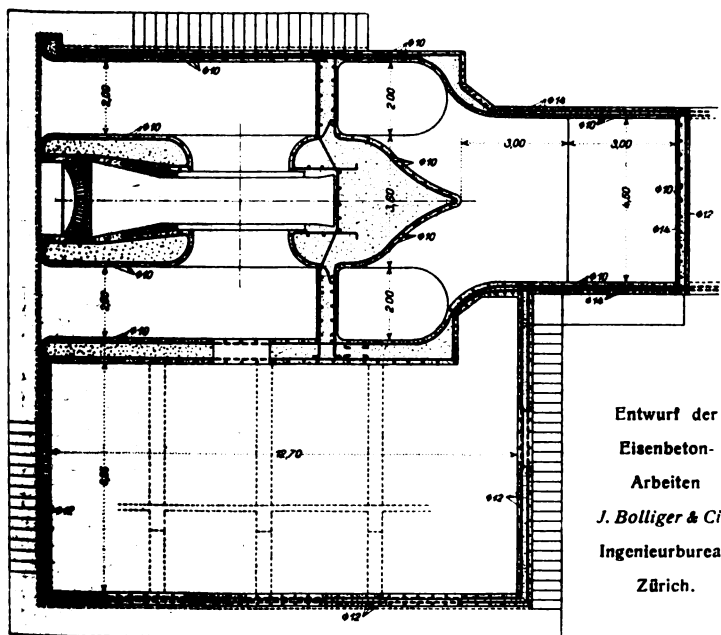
Horizontalschnitt im Obergeschoss. — 1:200.
